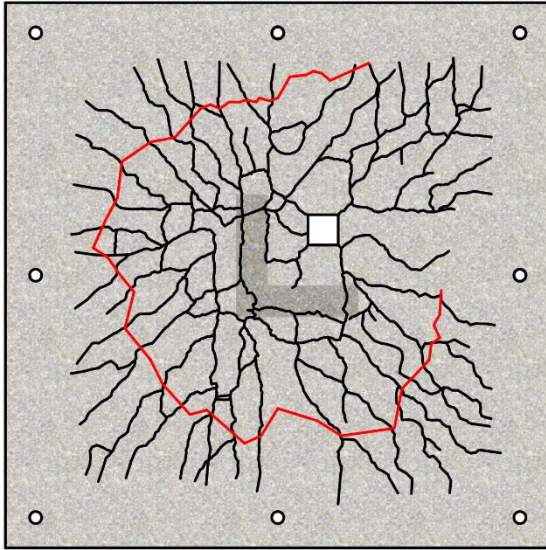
Padrão de fissuração da laje L2
